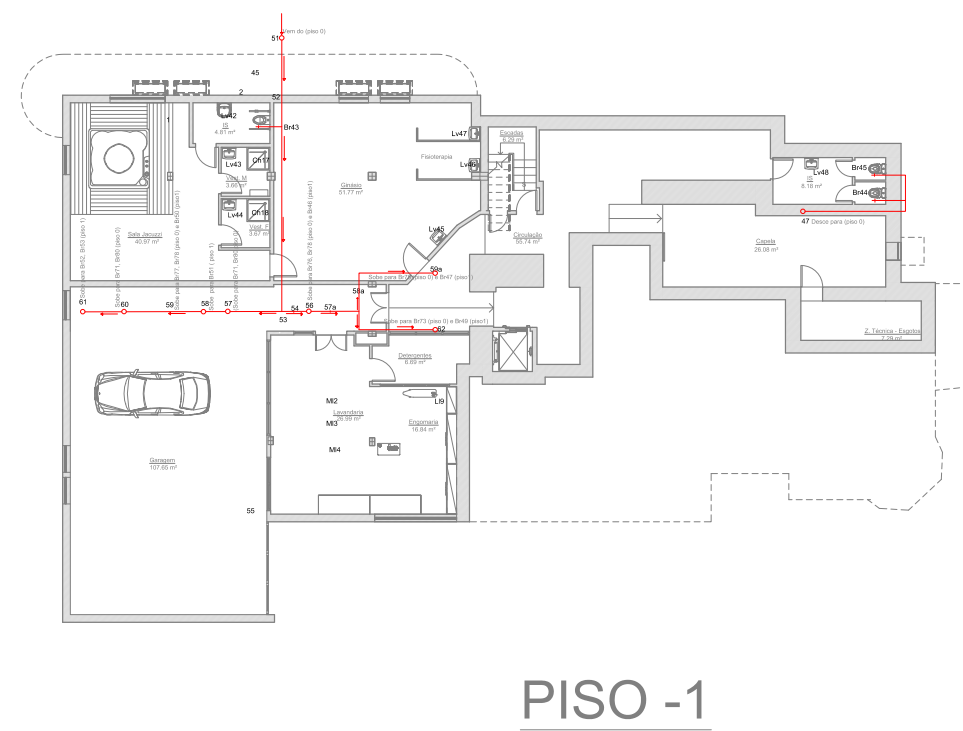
Rede de abastecimento de águas pluviais recicladas nos edifícios existentes e em construção -Piso 1 (Esc. 1/200)
